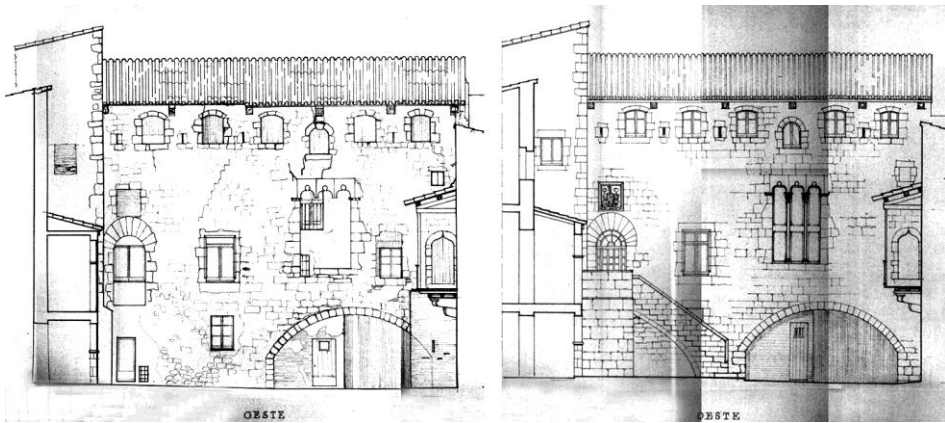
Monasterio de San Salvador de Breda. Palacio del Abad AAFV. Planos de proyecto, estado inicial y propuesta de intervención
